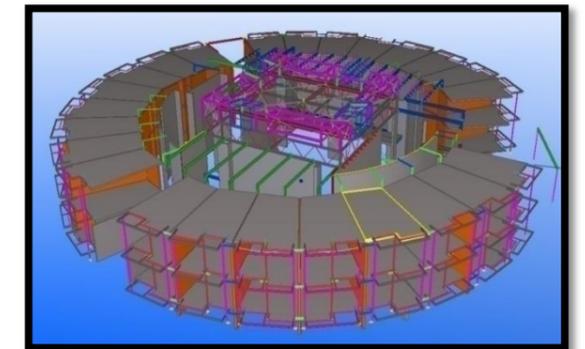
les matériaux de construction au niveau d'hôtel source : www.archidailly.com
